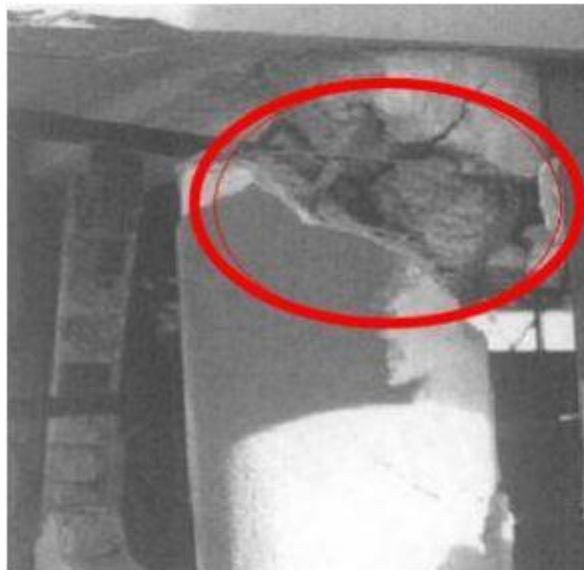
Rupture par cisaillement d'un poteau béton armé lors du séisme de Boumerdes 2003. [13]
